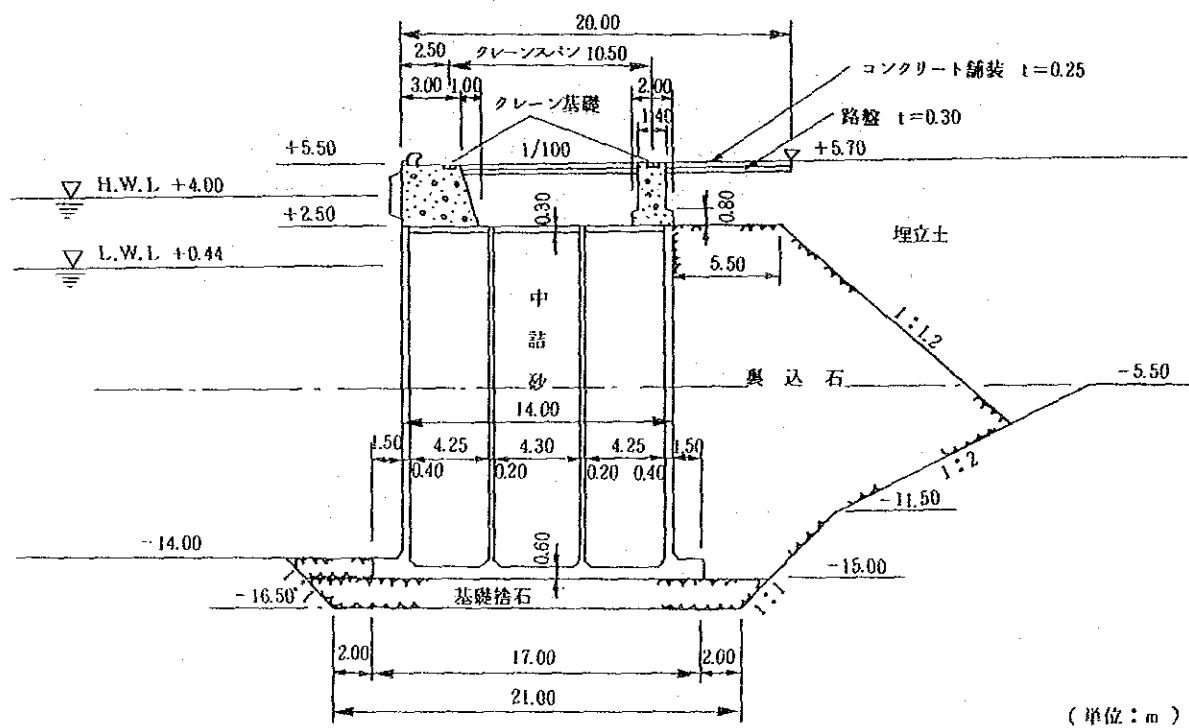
(a) 岸壁(-13m) ⑤⑥標準断面図
